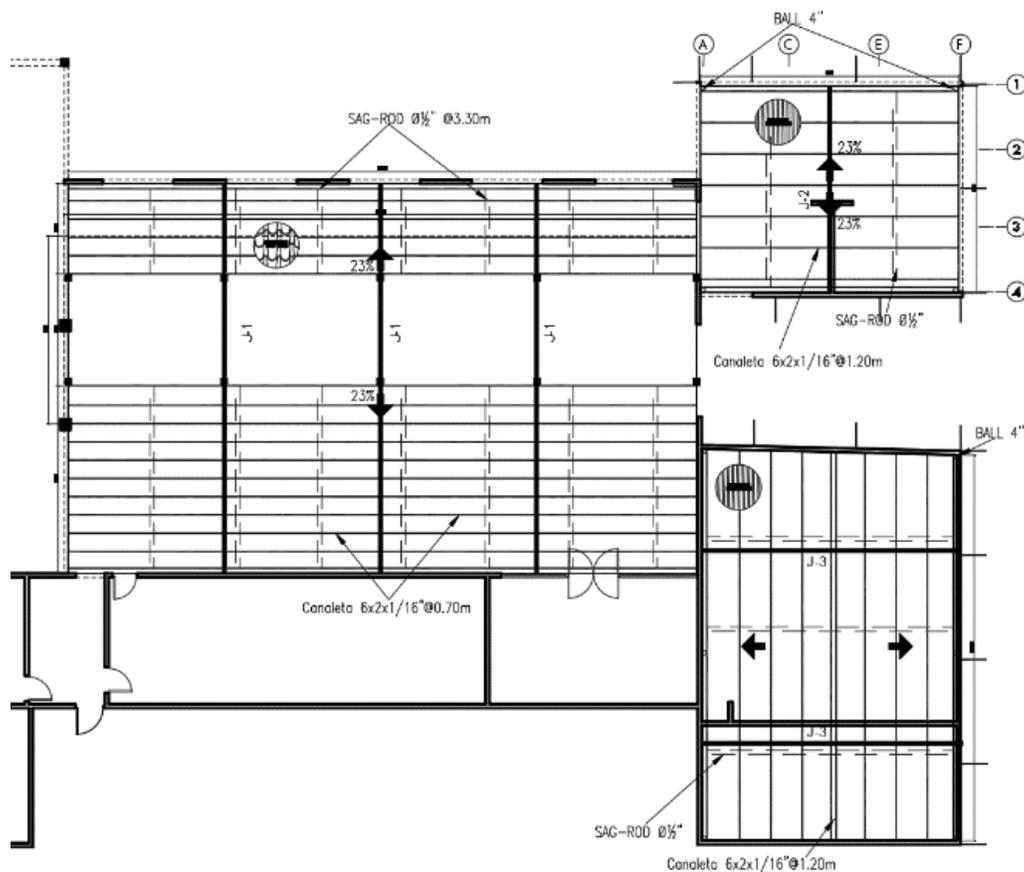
Plano de Estructuras de Cubiertas Inferiores
